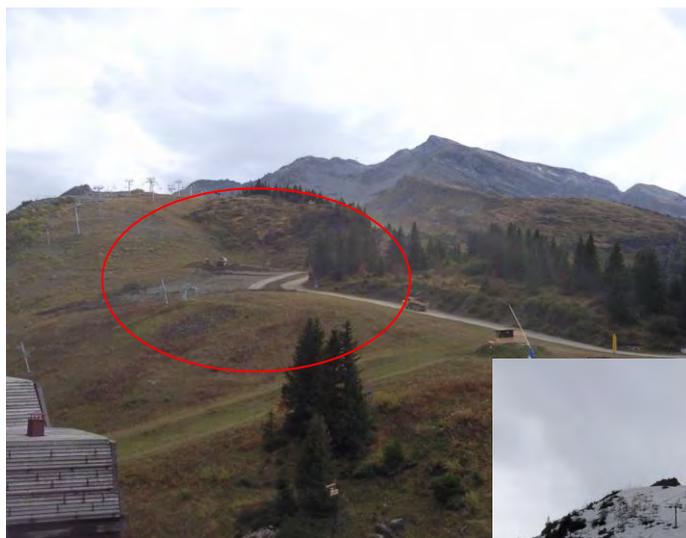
Exemple d'aplanissement de pistes sur Avoriaz.
